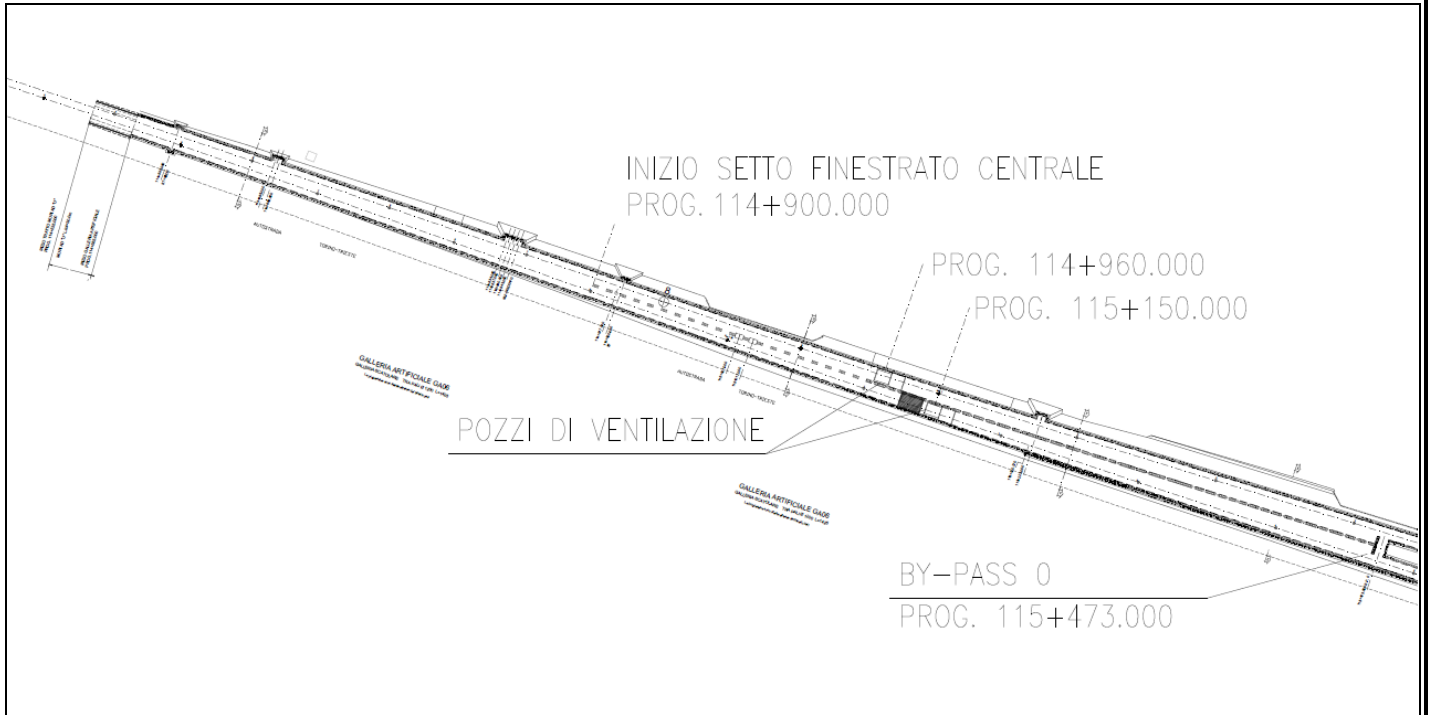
Stralcio di planimetria, zona interessata dalla disconnessione aeraulica
